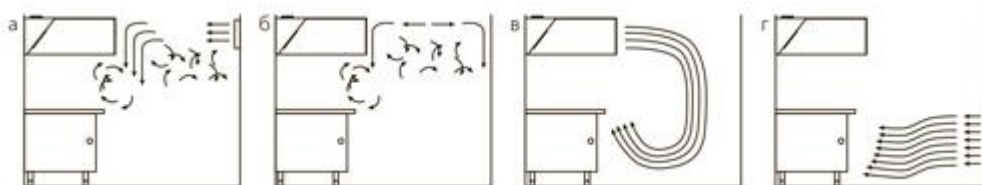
Способы воздухораспределения в горячих цехах: а, б – перемешивающая вентиляция; в, г – вытесняющая вентиляция
